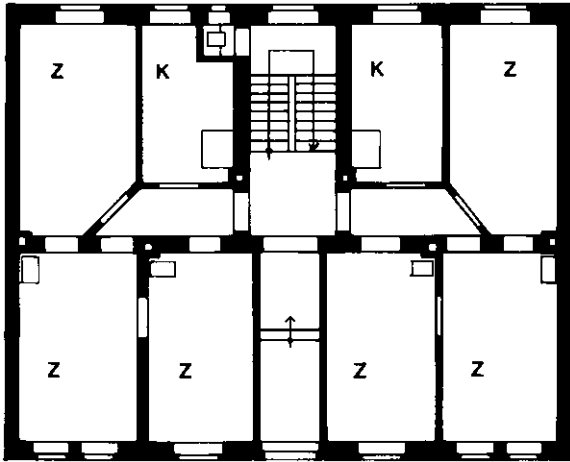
1902. Erdgeschoß der Berliner Chaussee 49.
